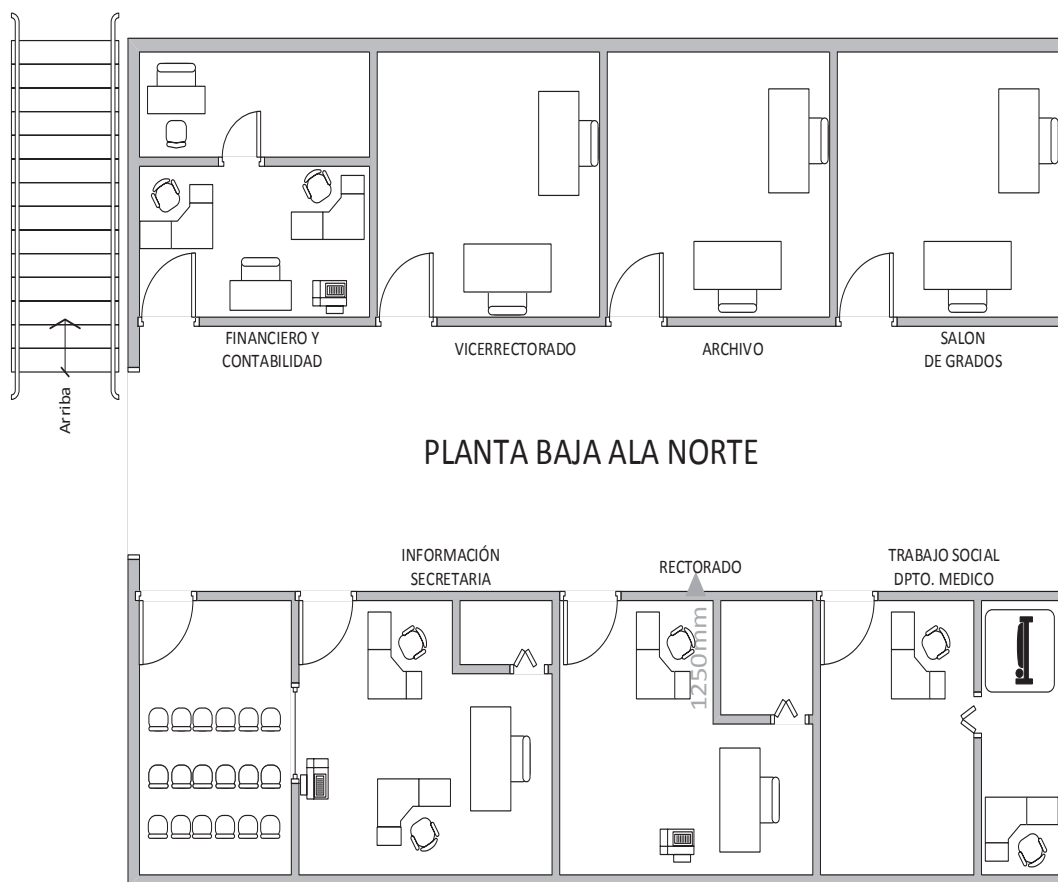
Distribución de las áreas Planta Baja ala norte
